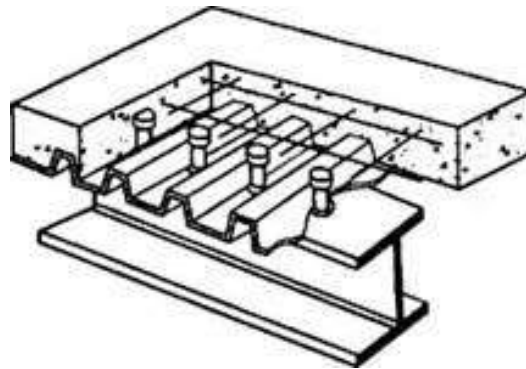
Конструкція сталезалізобетонного перекриття, що містить монолітну залізобетонну плиту, з'єднану зі сталевими профнастилом і балкою.
